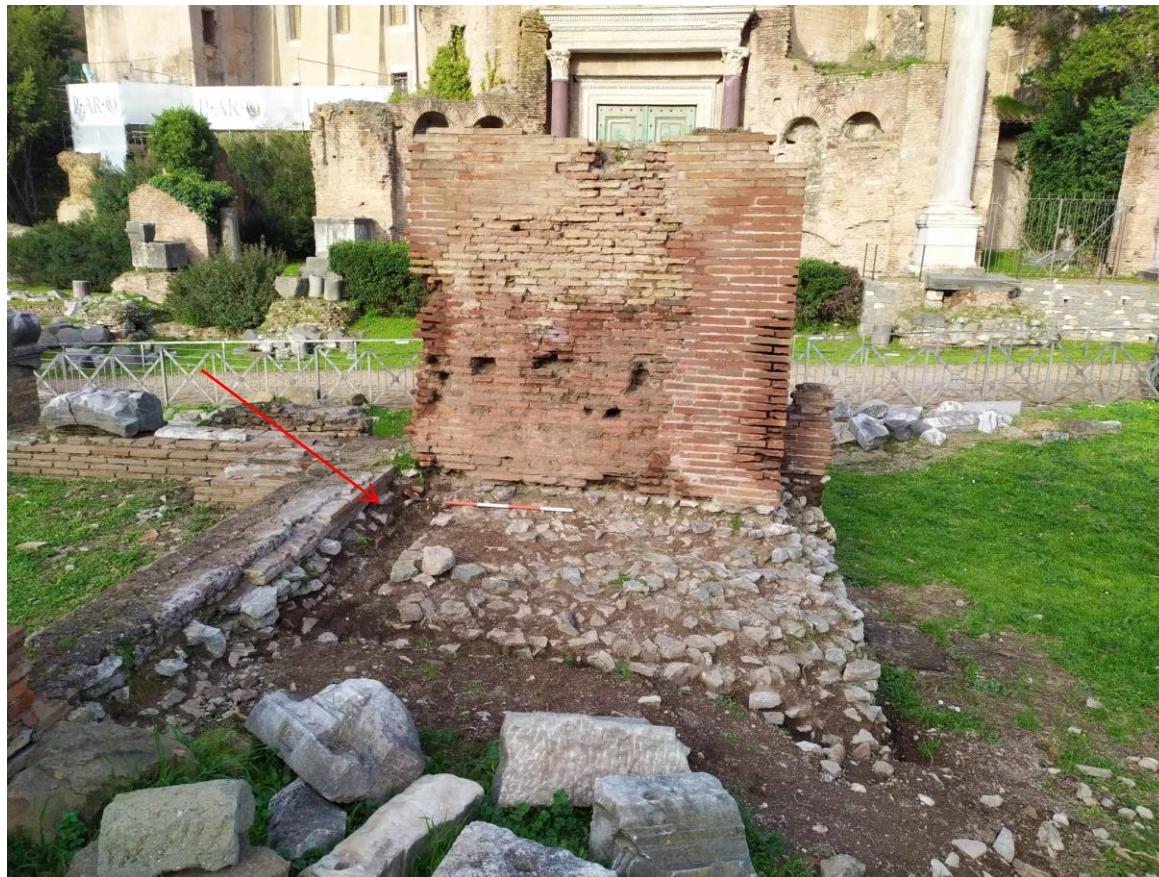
\_Area C, muro nord e fondazione in cementizio. La freccia indica il filo del nucleo in cementizio.
